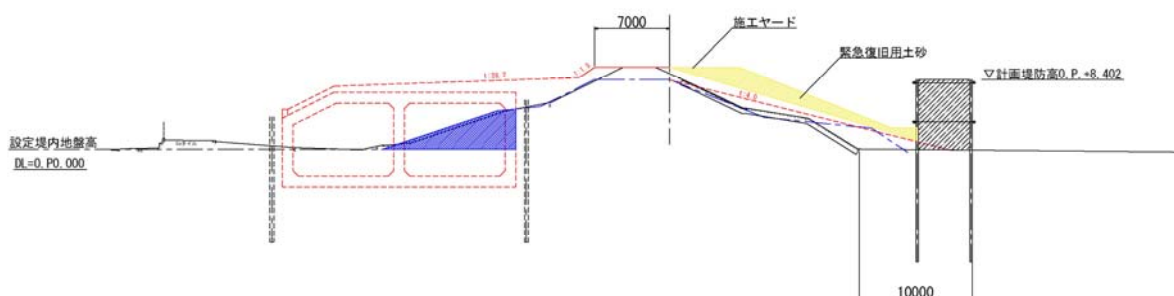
標準断面図（施工タイプ A）（次項へ続く）
